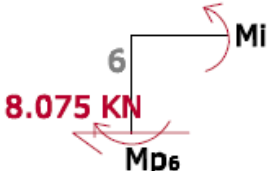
Cortantes en pilares del pórtico PY6 de la planta cubierta.
